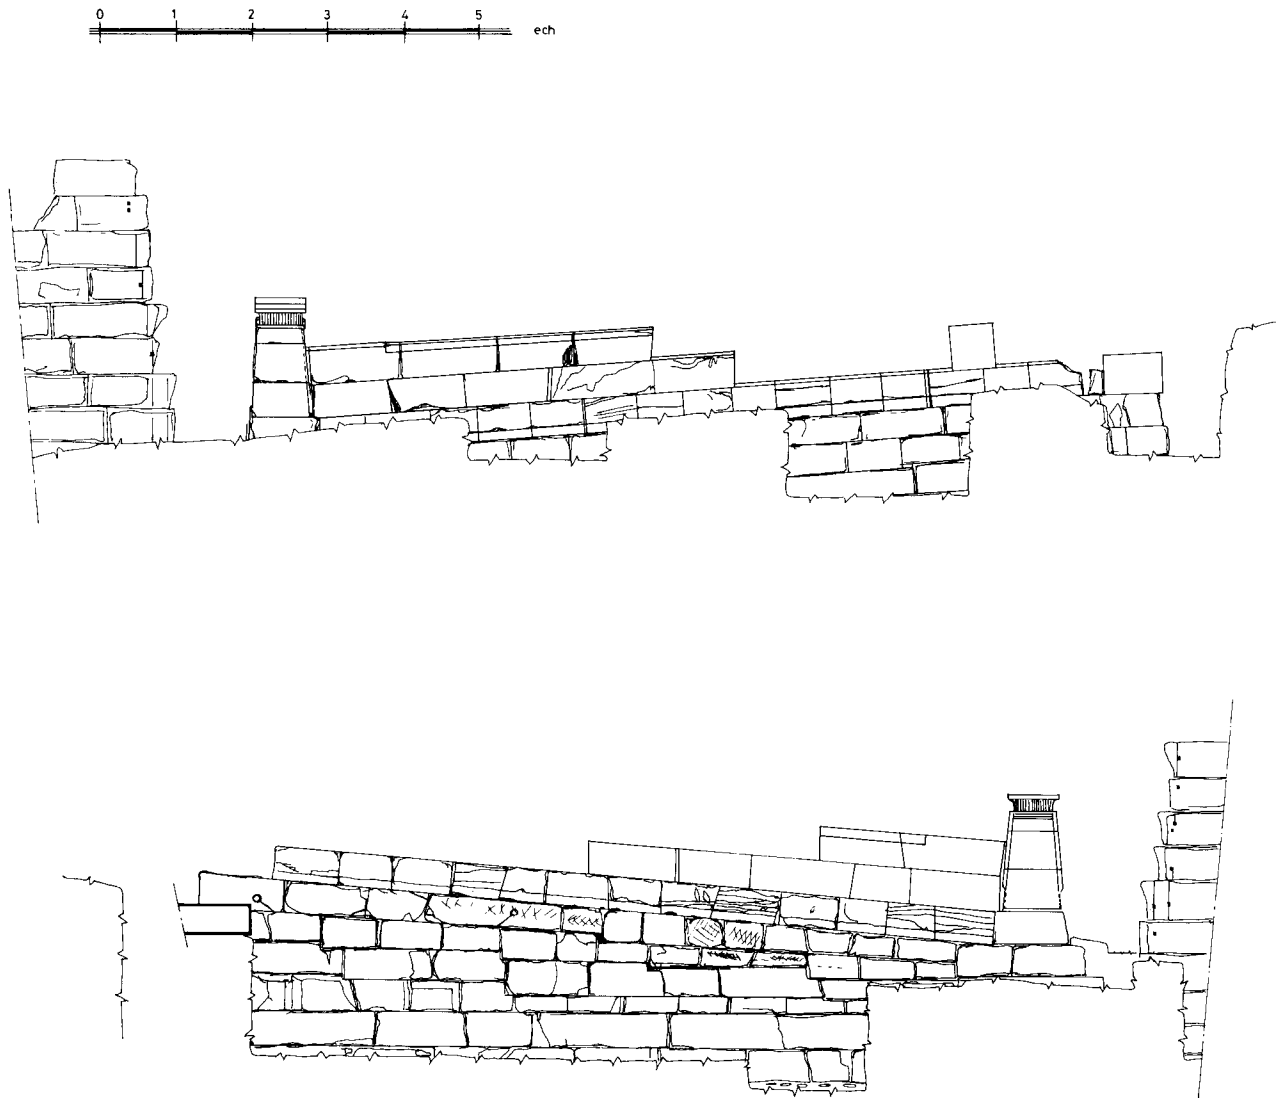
Élévations sud et nord des murs de support de la rampe avec amorce de la porte P.
